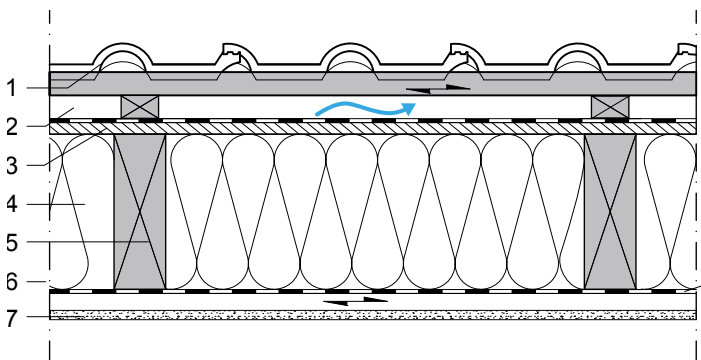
Dachaufbau GK 0 mit Bretterschälung
